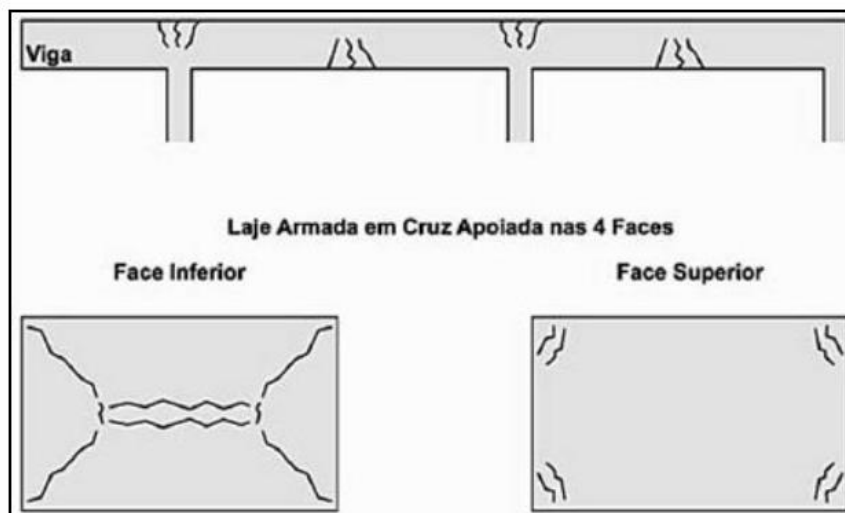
Fissura de Flexão simples em estrutura de concreto armado
